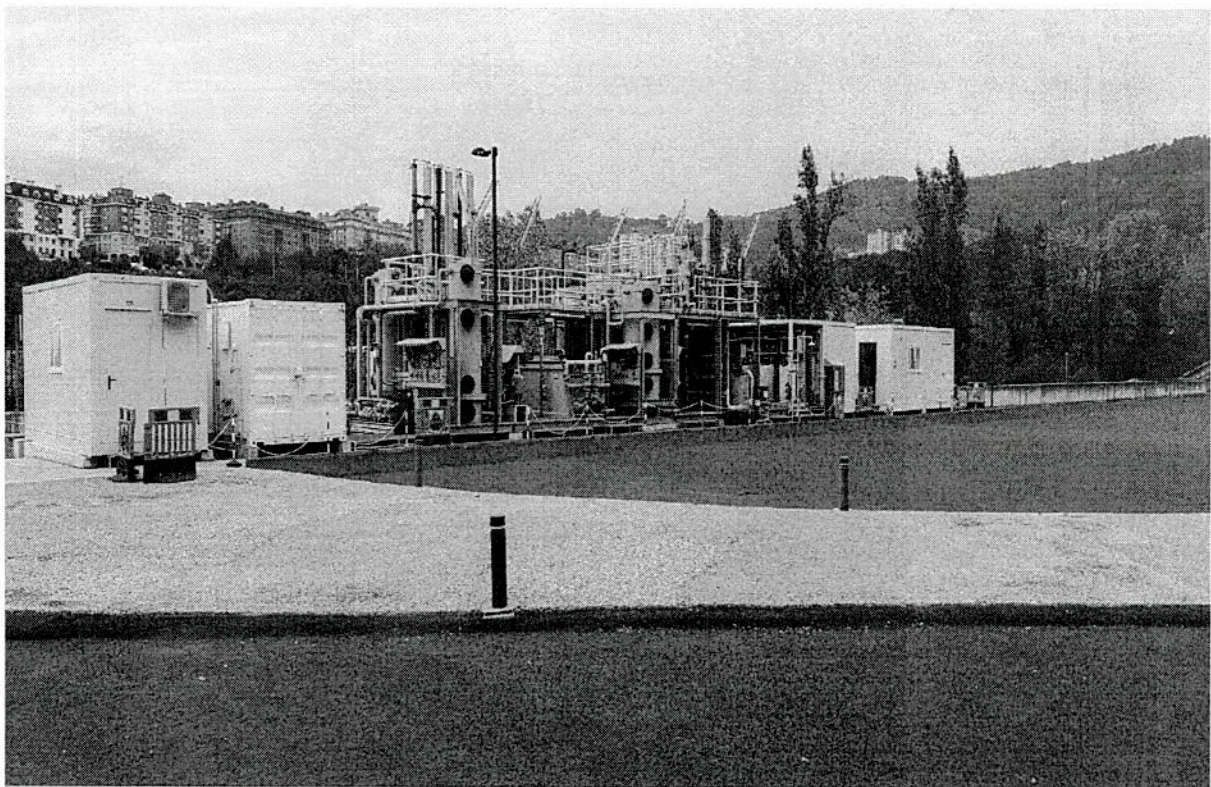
Vista general de la Planta Potabilizadora Venta Alta
